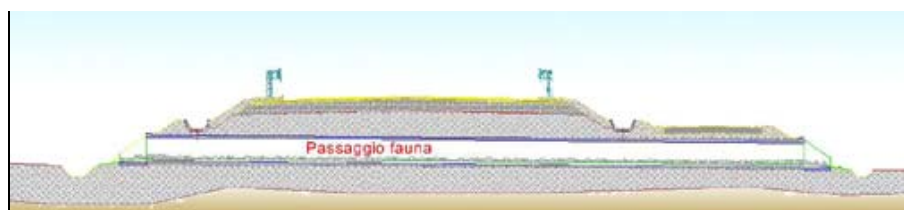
Sezione tipo per un passaggio sotto il manto stradale
